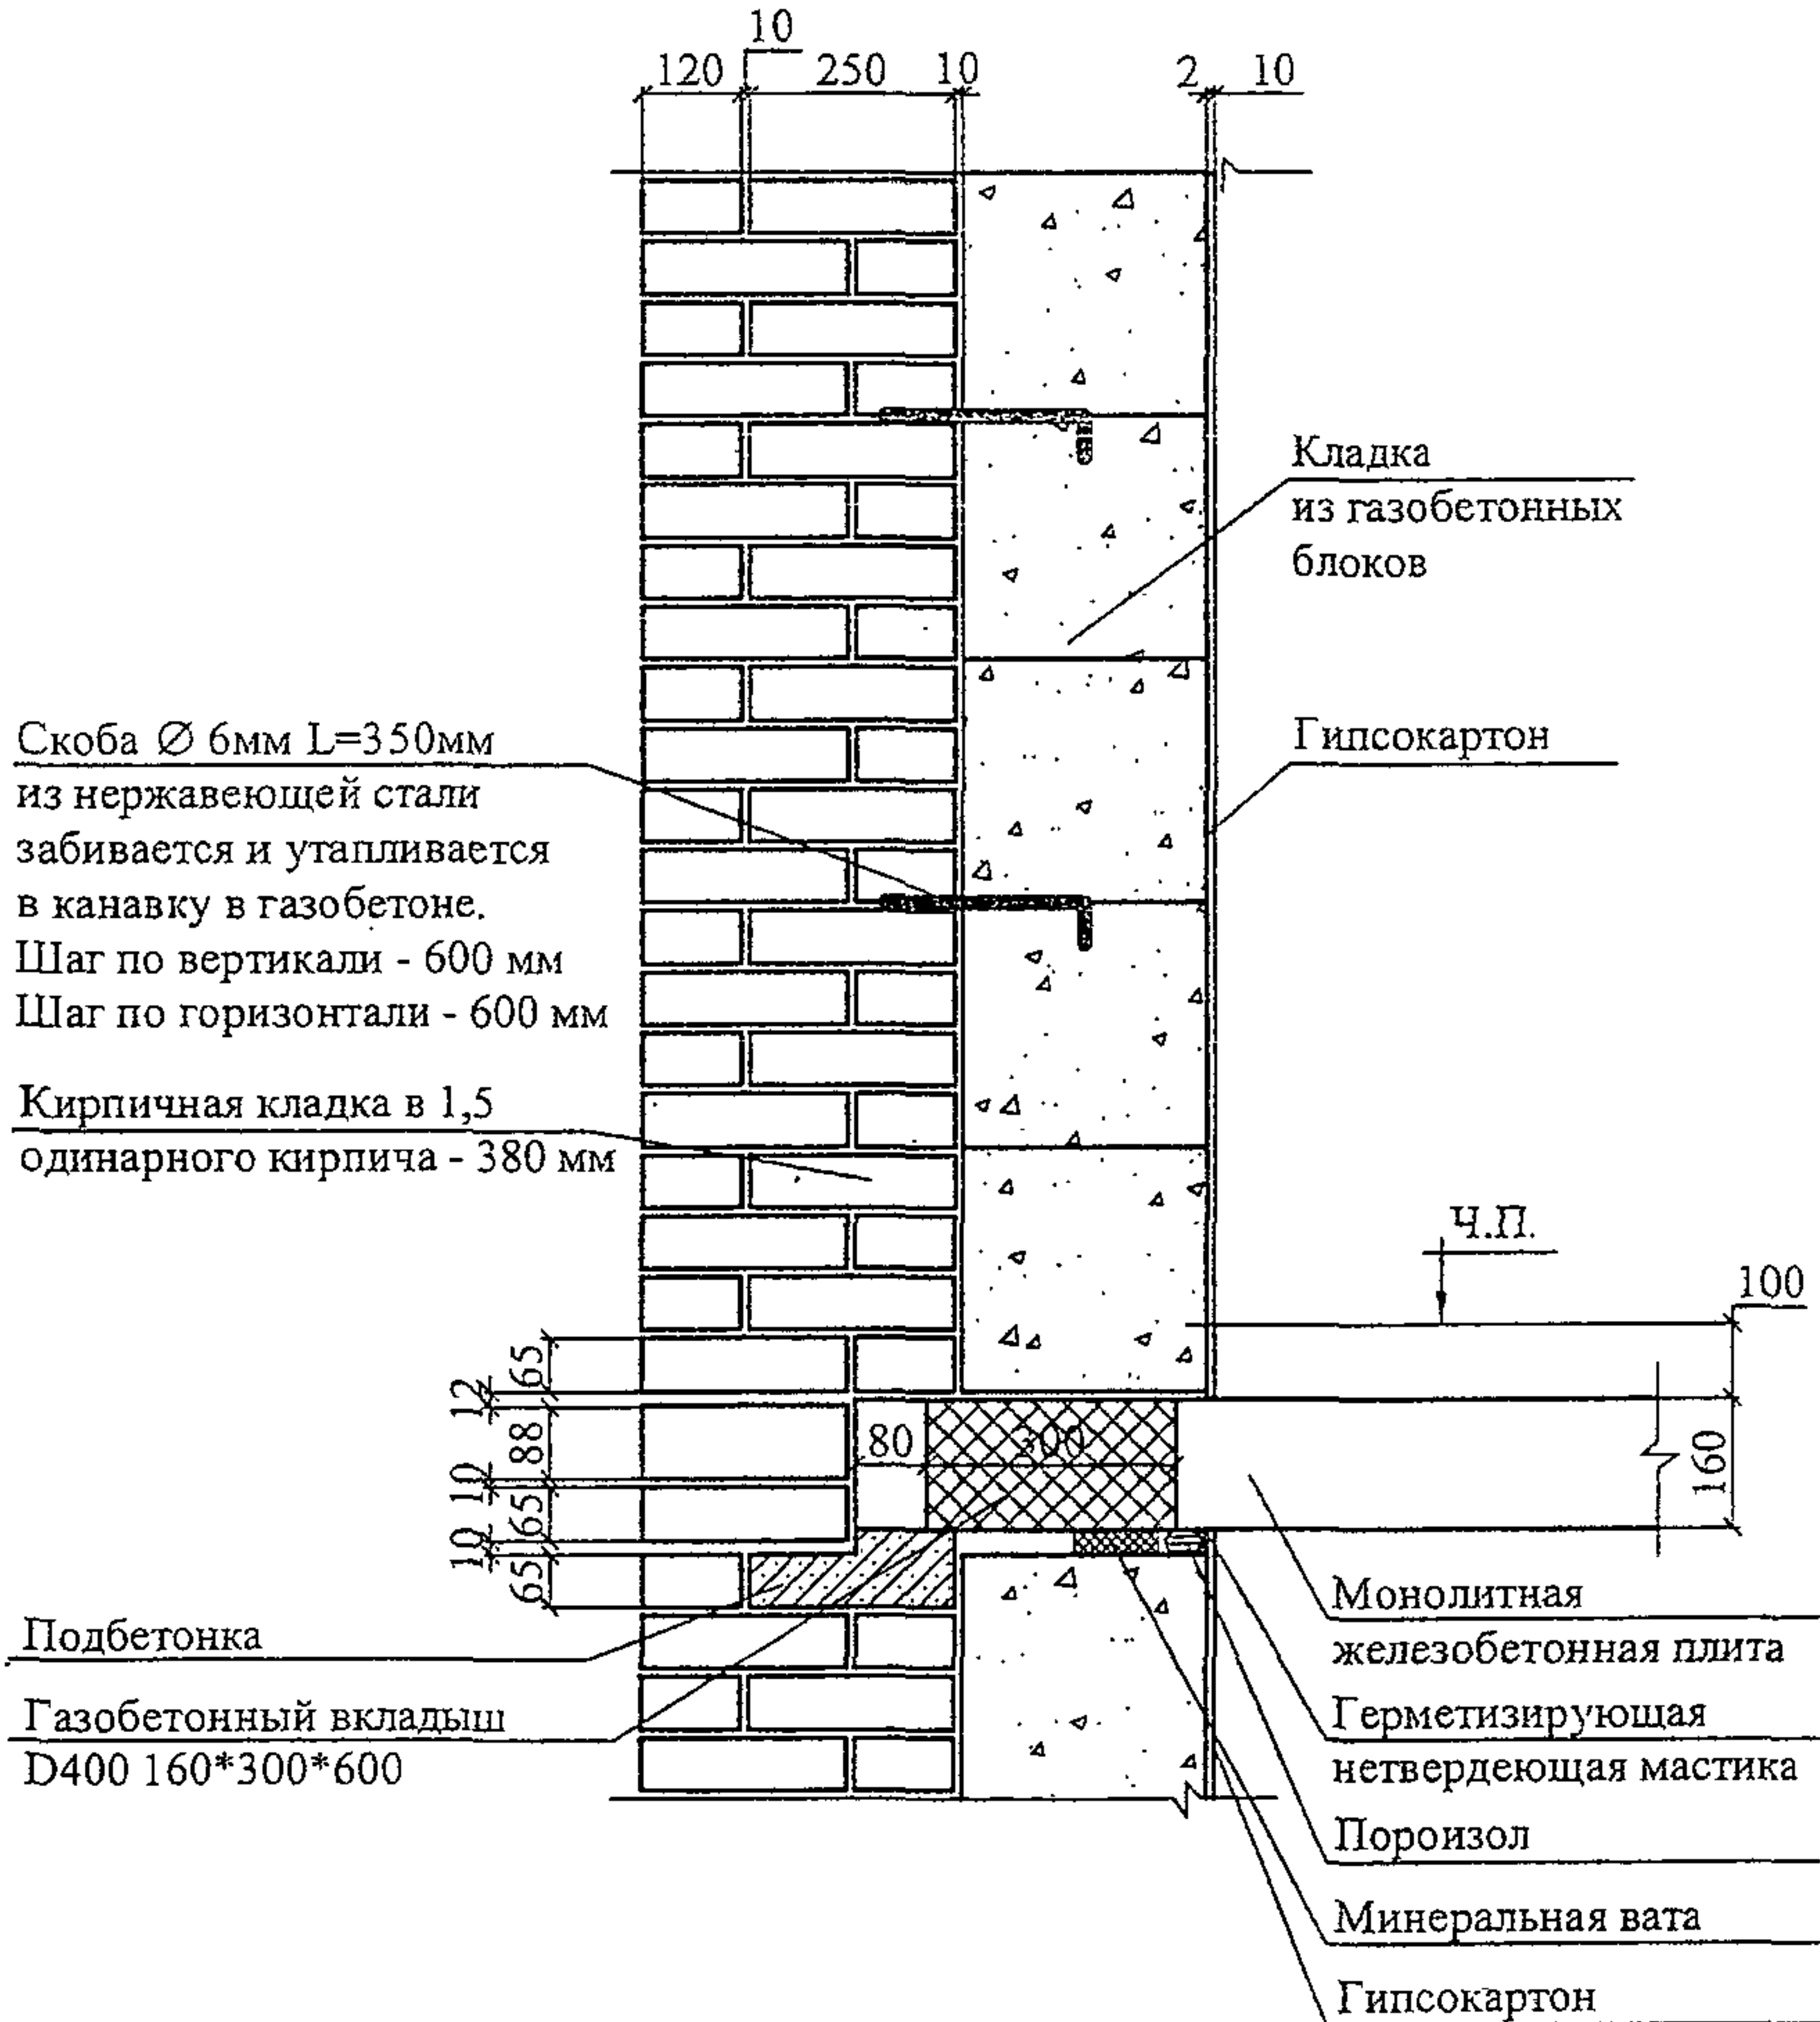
Несущая стена из кирпича с газобетонными блоками на клею
